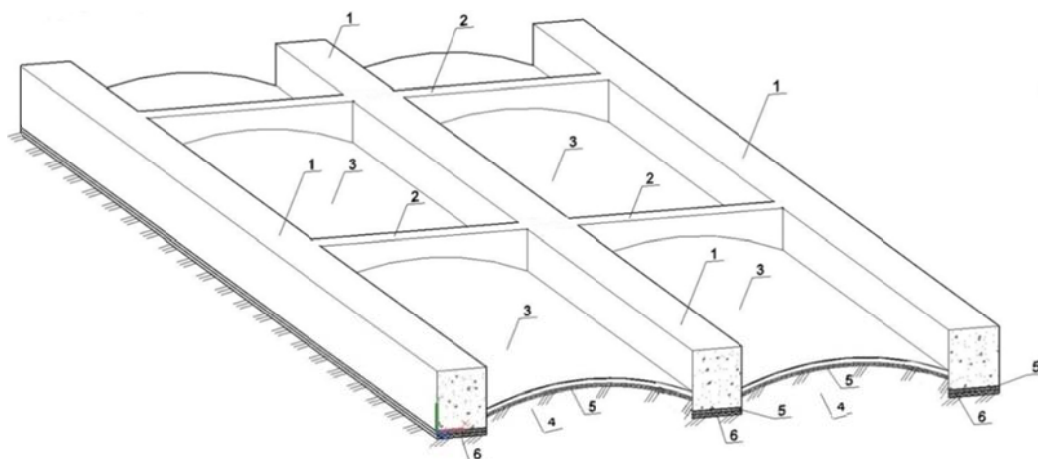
Общая конструкция ленточно-оболочечного фундамента:
